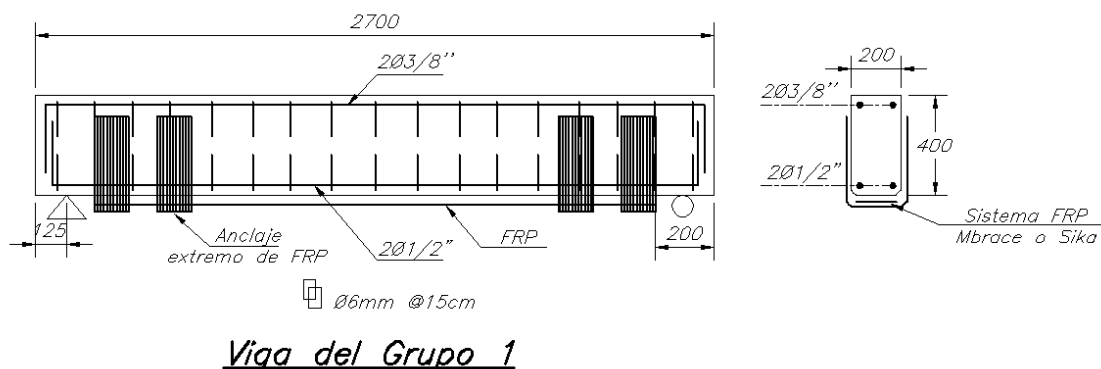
Esquema de las vigas ensayadas por Baca y Espinoza (2005).
